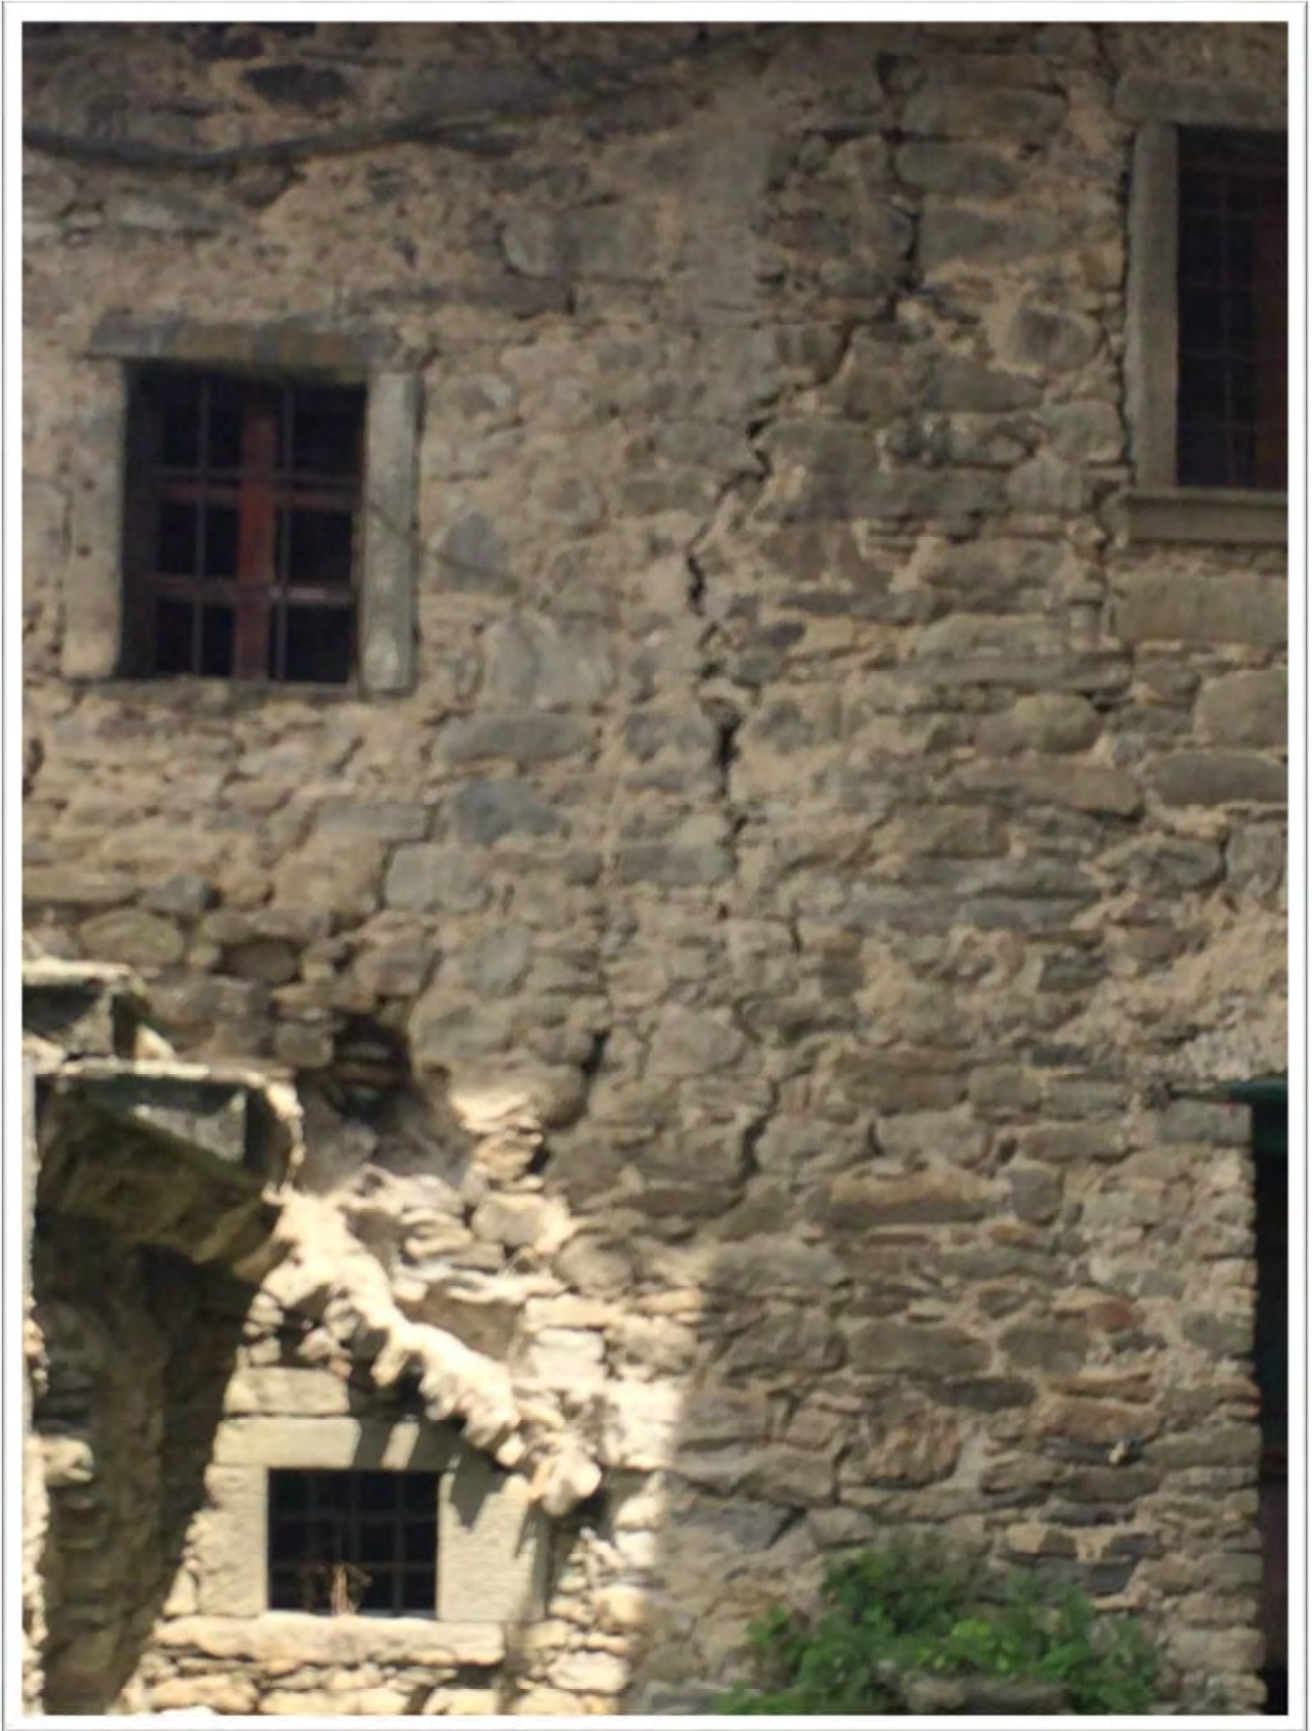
Scala crollata di accesso al piano secondo (corpo A)
